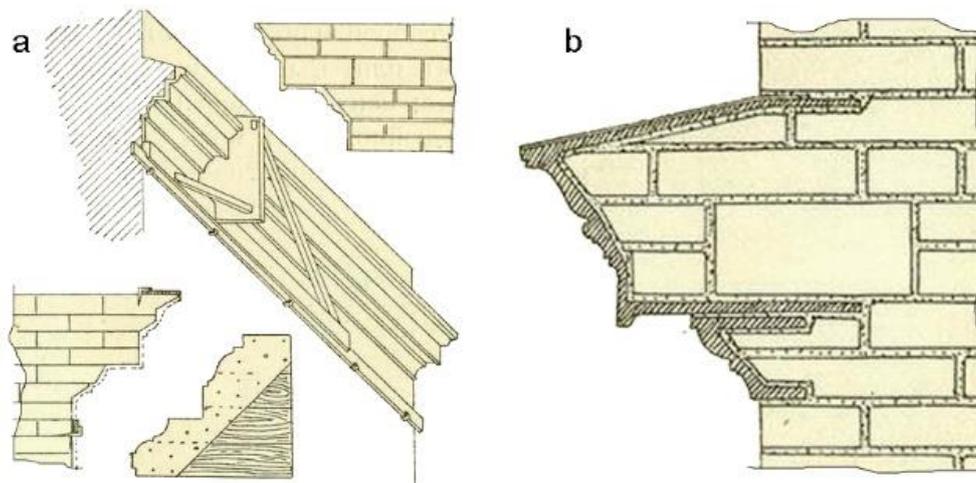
Штукатурный (а) и гончарный (b), или керамический, карнизы [32]
